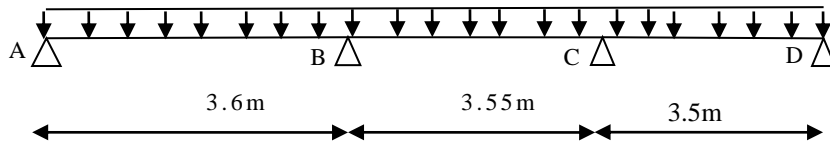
schéma statique d'une poutrelle du plancher terrasse
